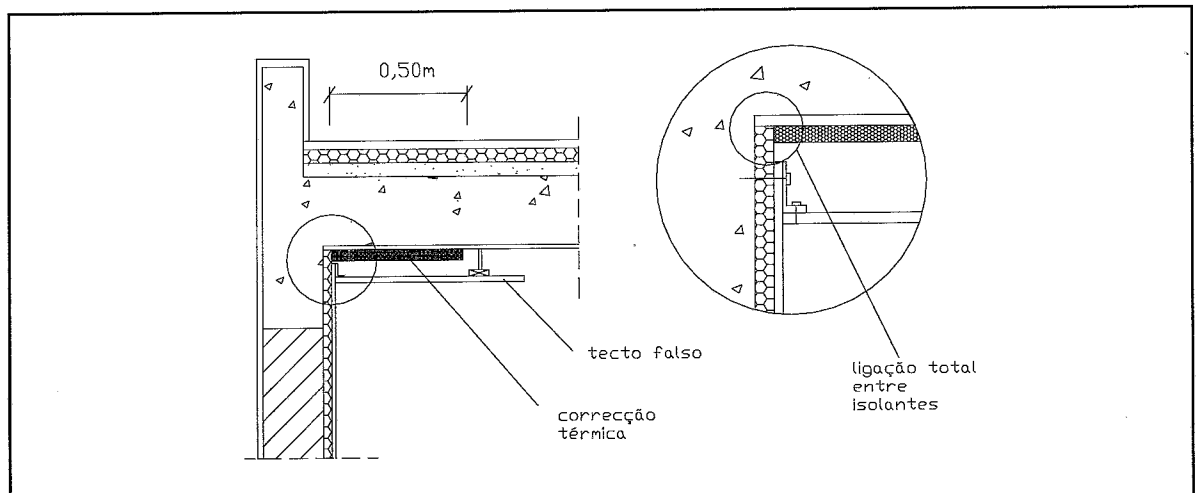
Pormenor da correcção térmica com prolongamento do isolante térmico interior em zona de ligação de parede com laje de cobertura
